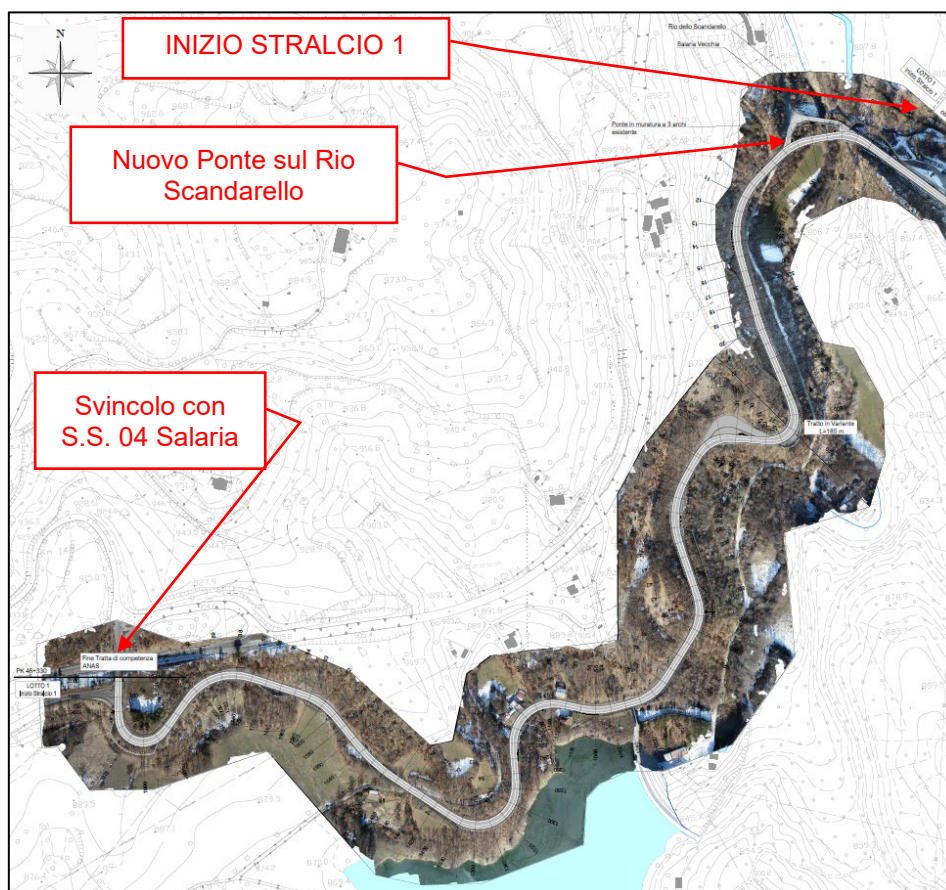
Stralcio 1 – Planimetria generale di progetto
